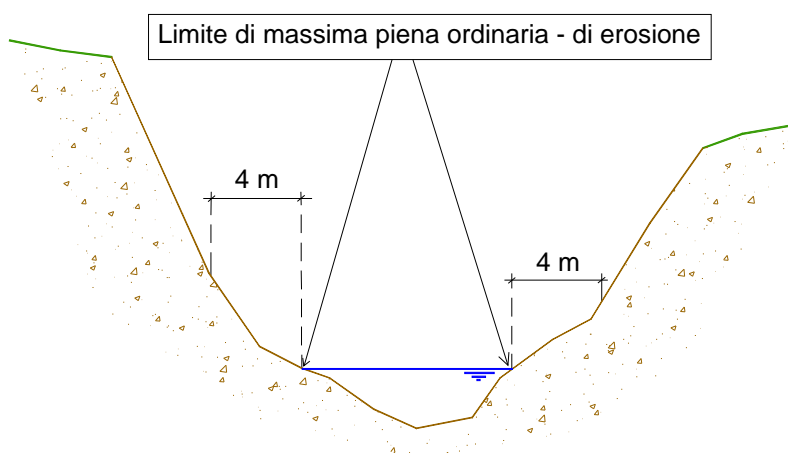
Schemi grafici per la definizione delle fasce di rispetto
